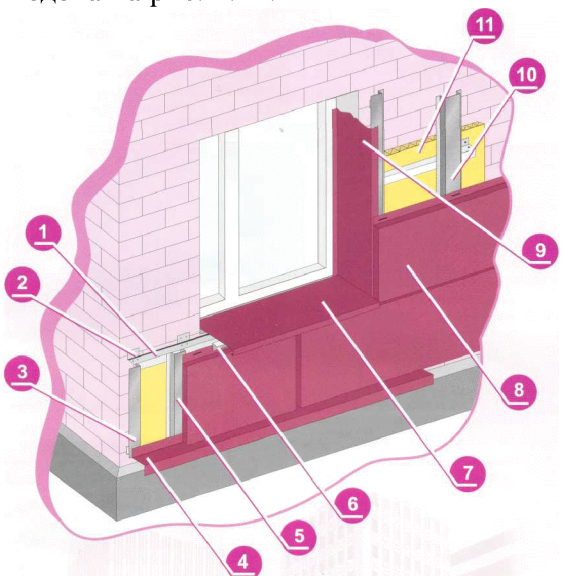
Технологическая схема монтажа металлической фасадной облицовки
